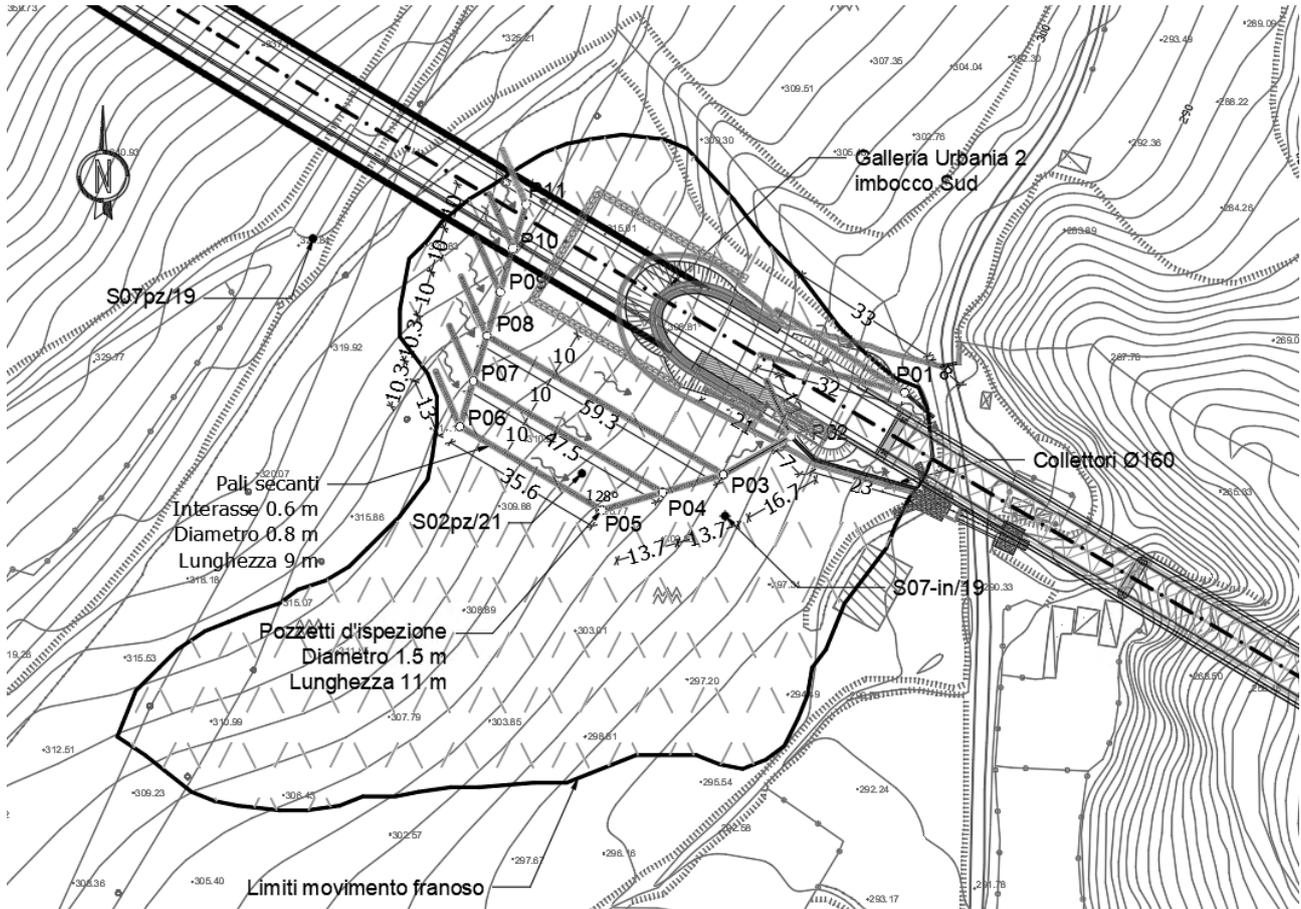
Schema della disposizione in pianta del sistema drenante costituito da pali secanti
